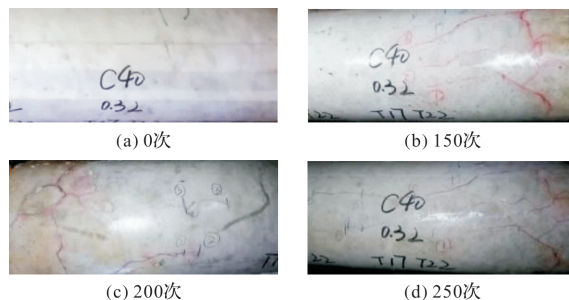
C40 混凝土圆柱体构件表面裂缝开展情况(C40-32)
